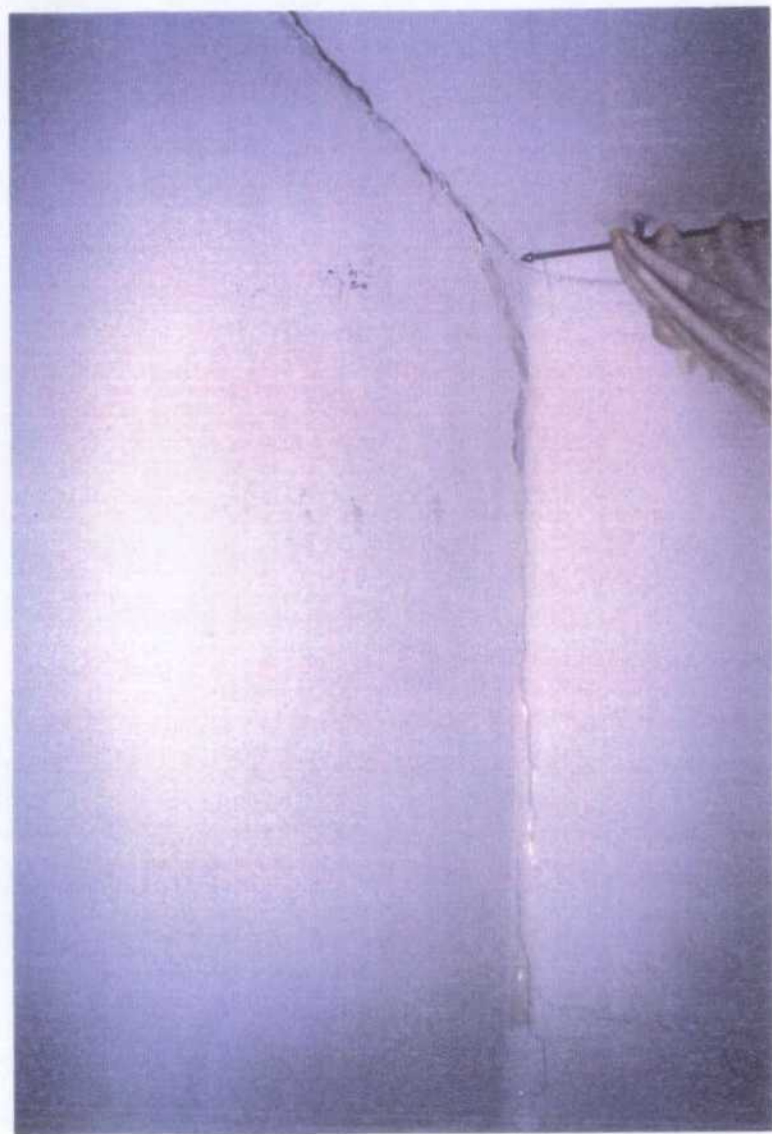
Grietas selladas con cinta adhesiva para aislar del exterior.
